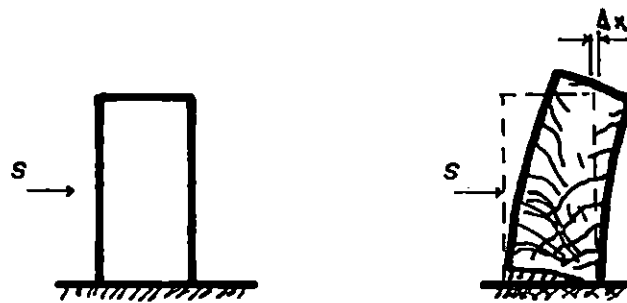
DAÑOS EN MUROS DE CONCRETO REFORZADO
